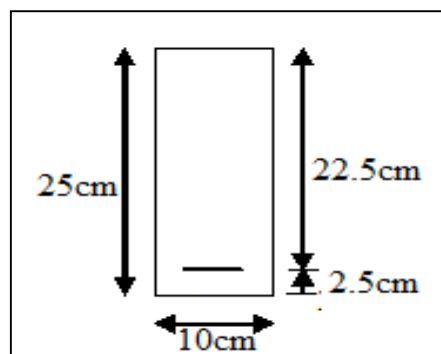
Section théorique pour le ferrailage du plancher (sur appui)
